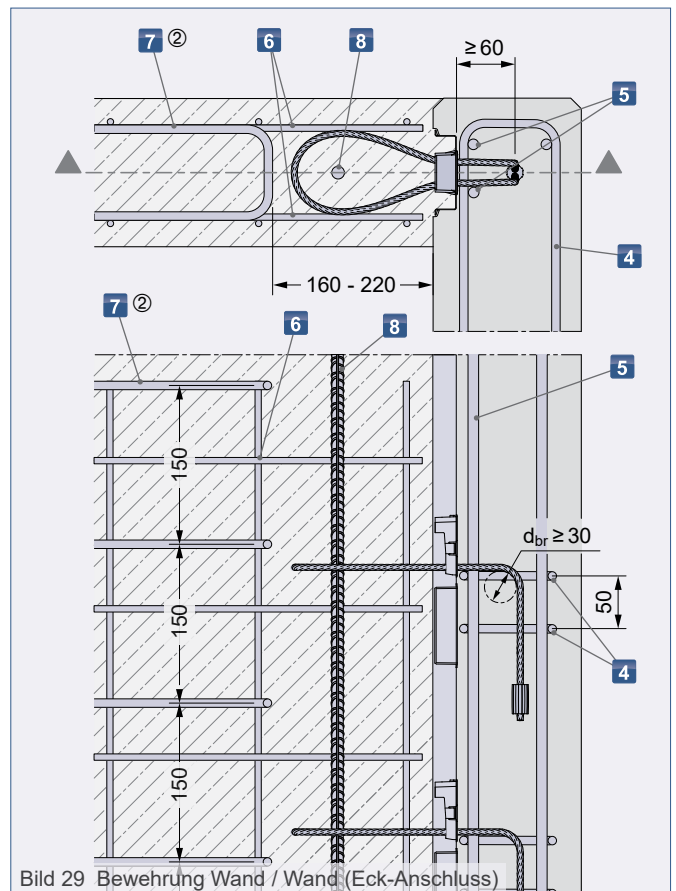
Bewehrung Wand / Wand (Eck-Anschluss)
